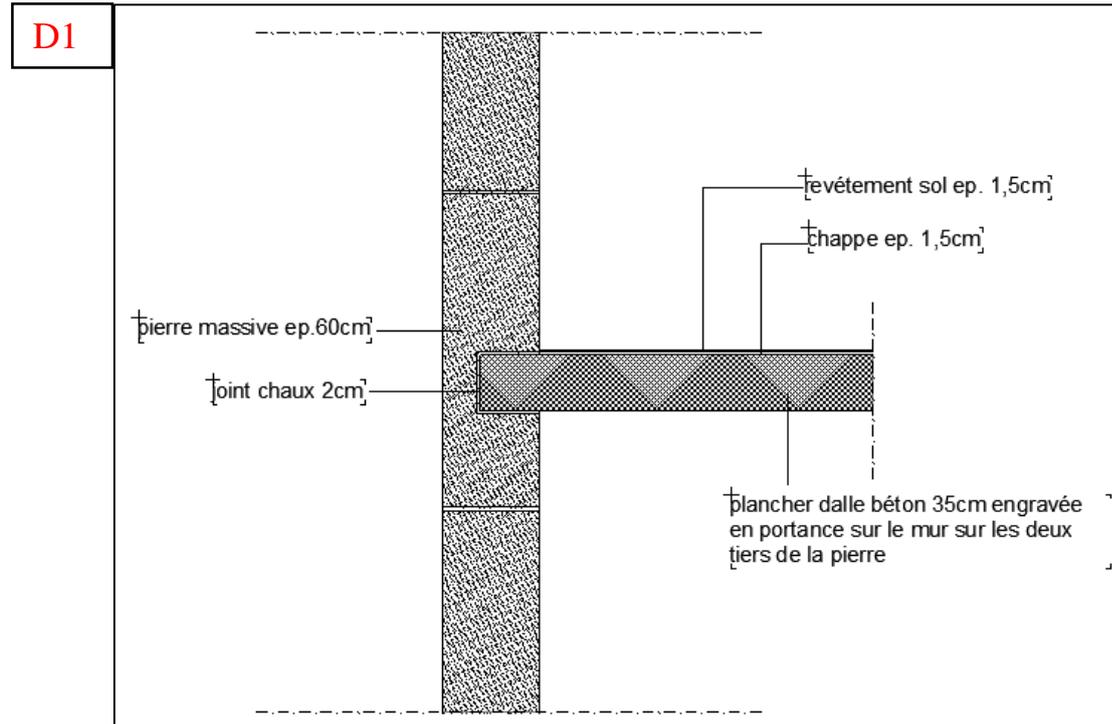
Détail de construction d'un mur en pierre et plancher en béton (source : auteur).
